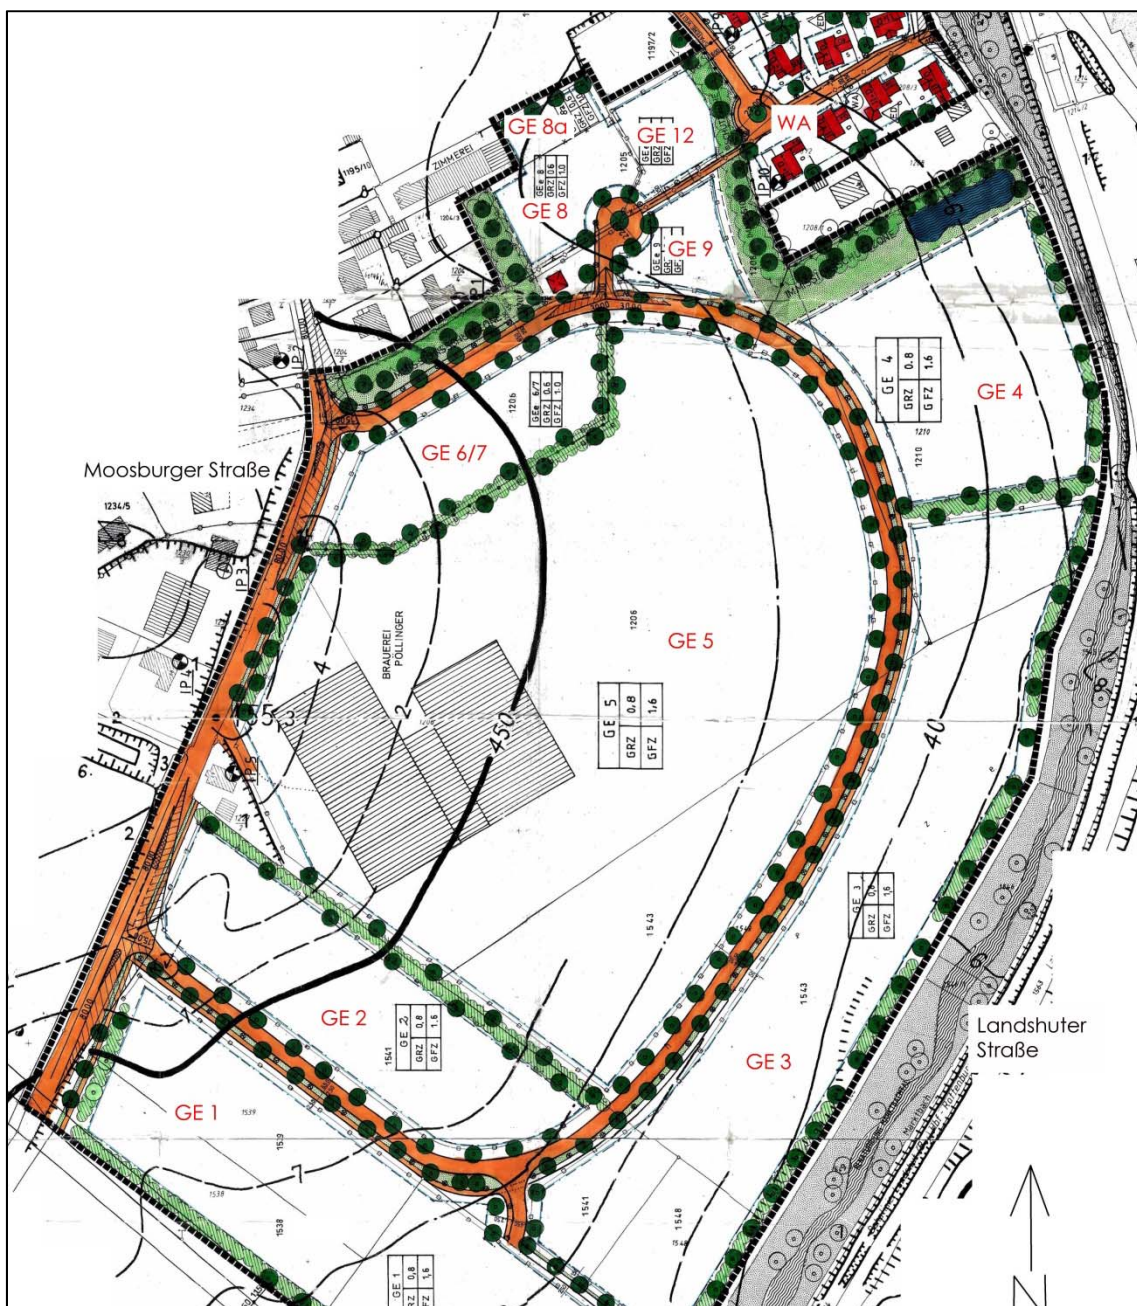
Planzeichnung zum Bebauungsplan "GE an der Moosburger Straße" /69/
